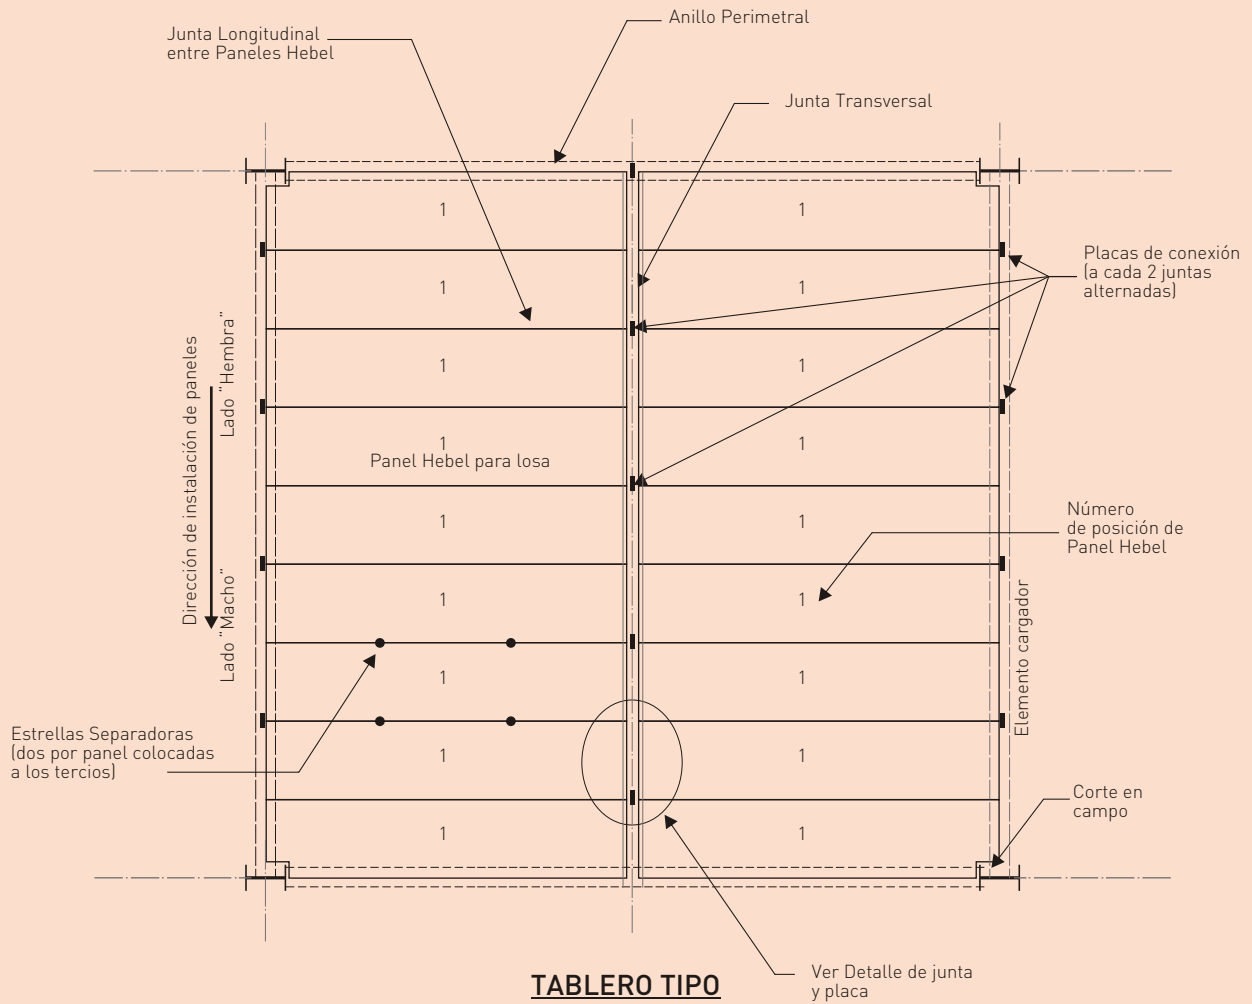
Tablero tipo de apoyo de paneles sobre estructura de acero.
